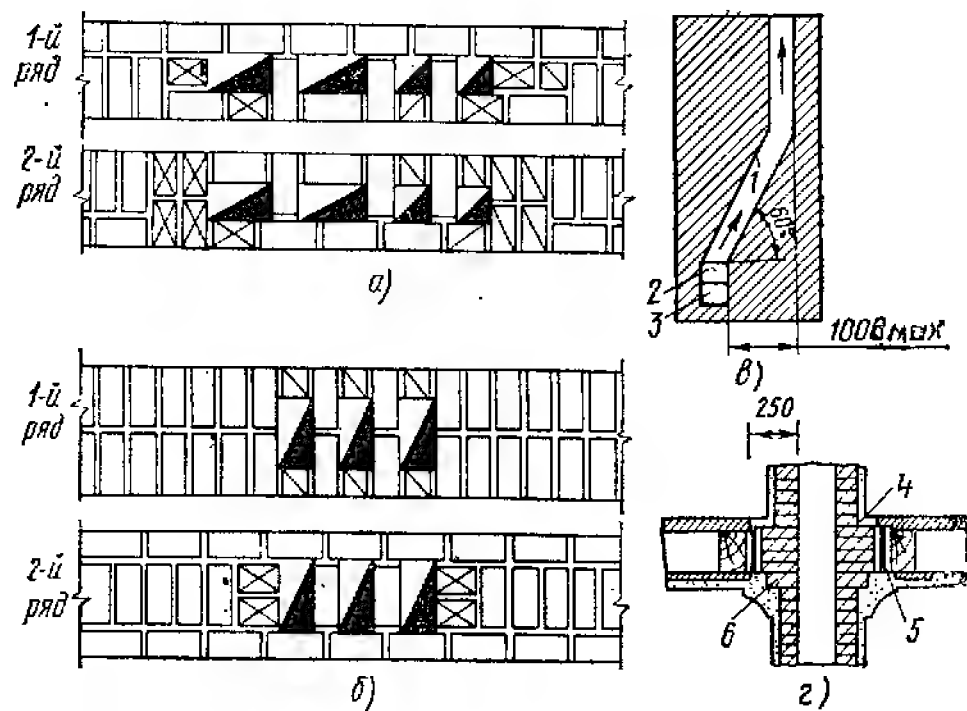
Вентиляционные каналы и газоходы в стенах (а, б), отвод канала (в), разделка дымохода у деревянного перекрытия (г):
